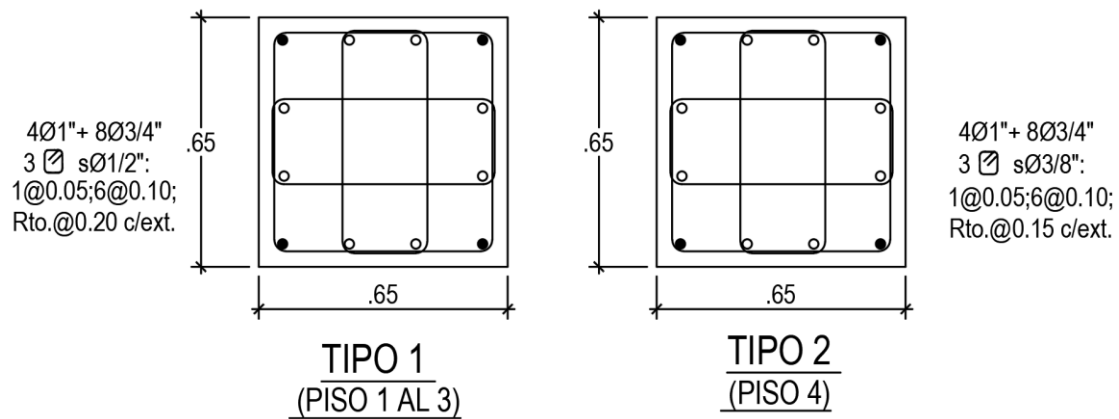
Esquema de las armaduras de columnas C1-SD
